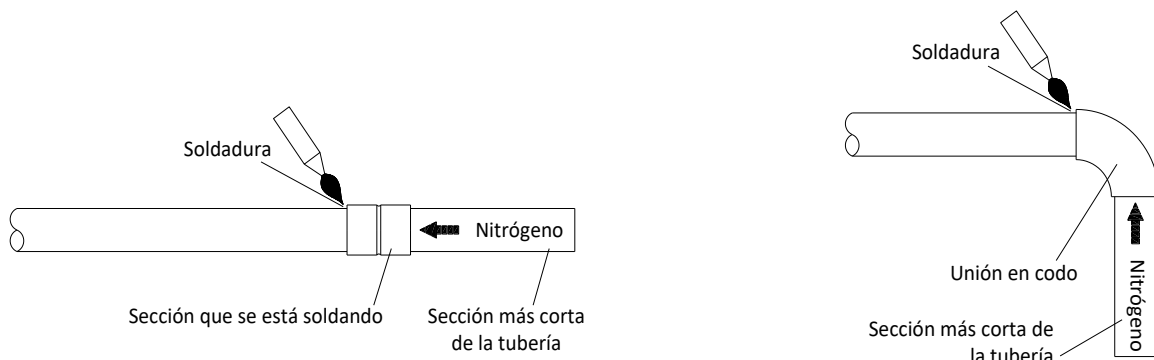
Injectar nitrógeno en las tuberías durante la soldadura
